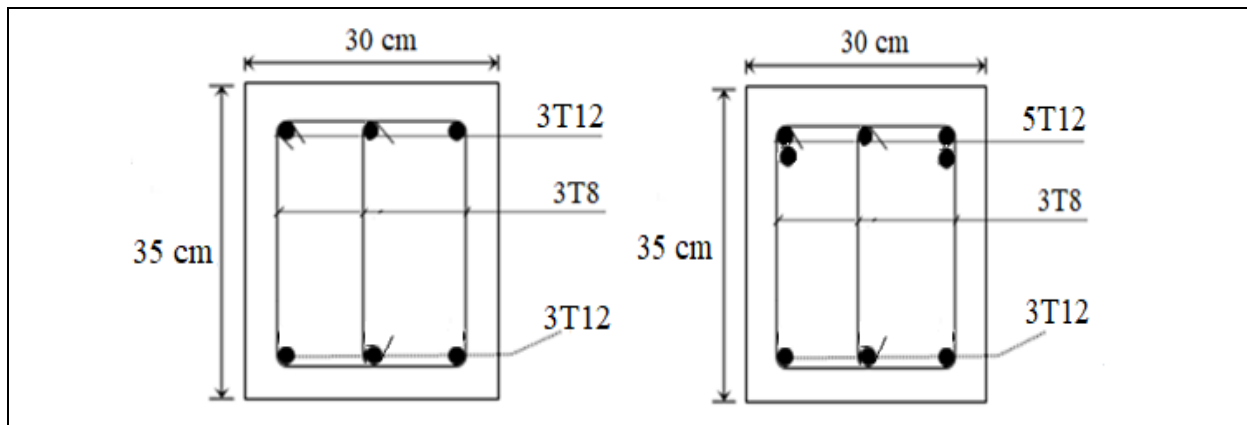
Ferraillage de la poutre palière en appui et en travée
